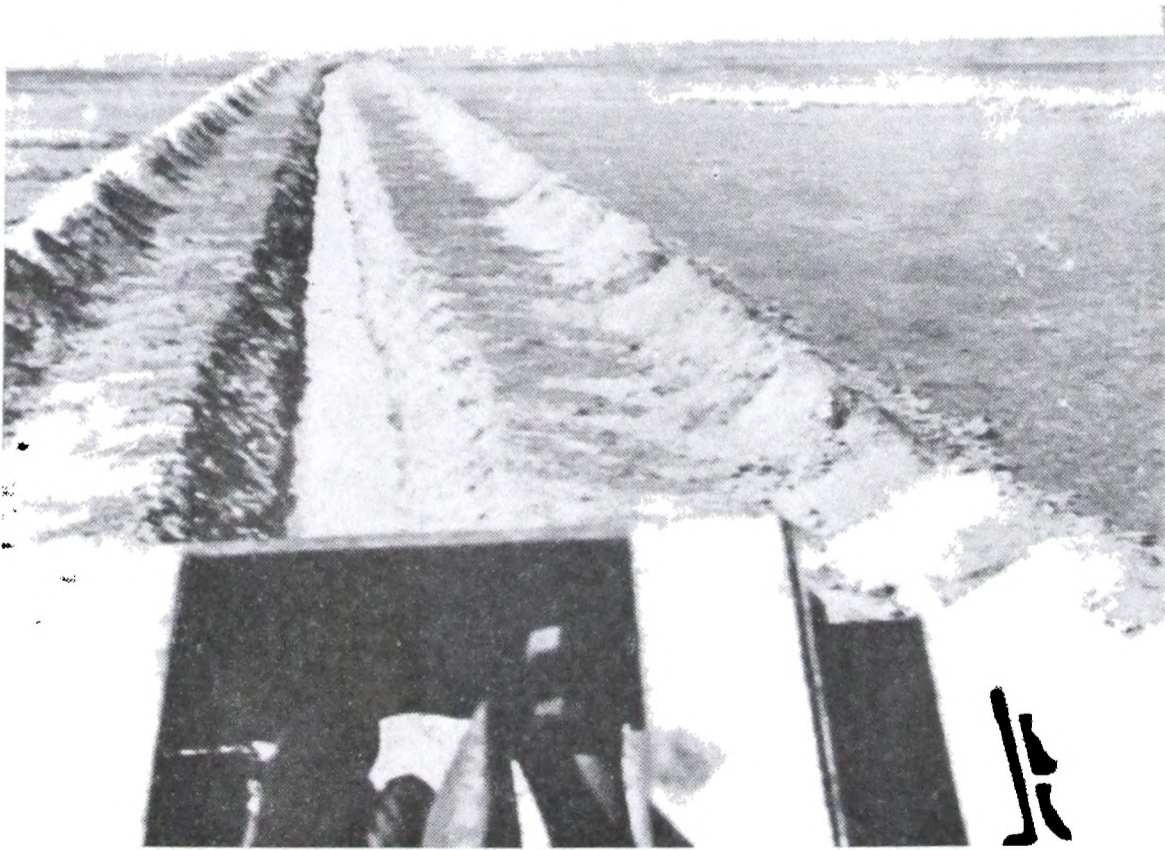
Plan de obras de «El Tordillo». Trecho del Canal Principal en ejecución.
